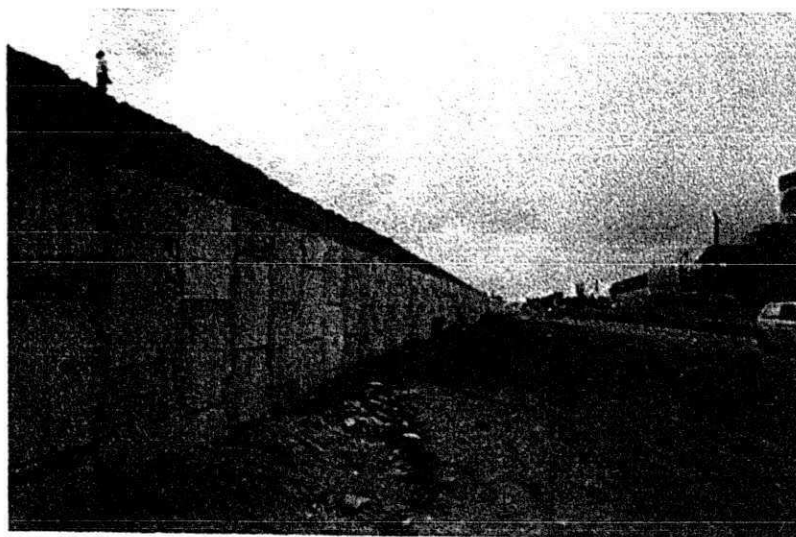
Detalhe do murro de arrimo do viaduto de Gravatá na estaca 400.
